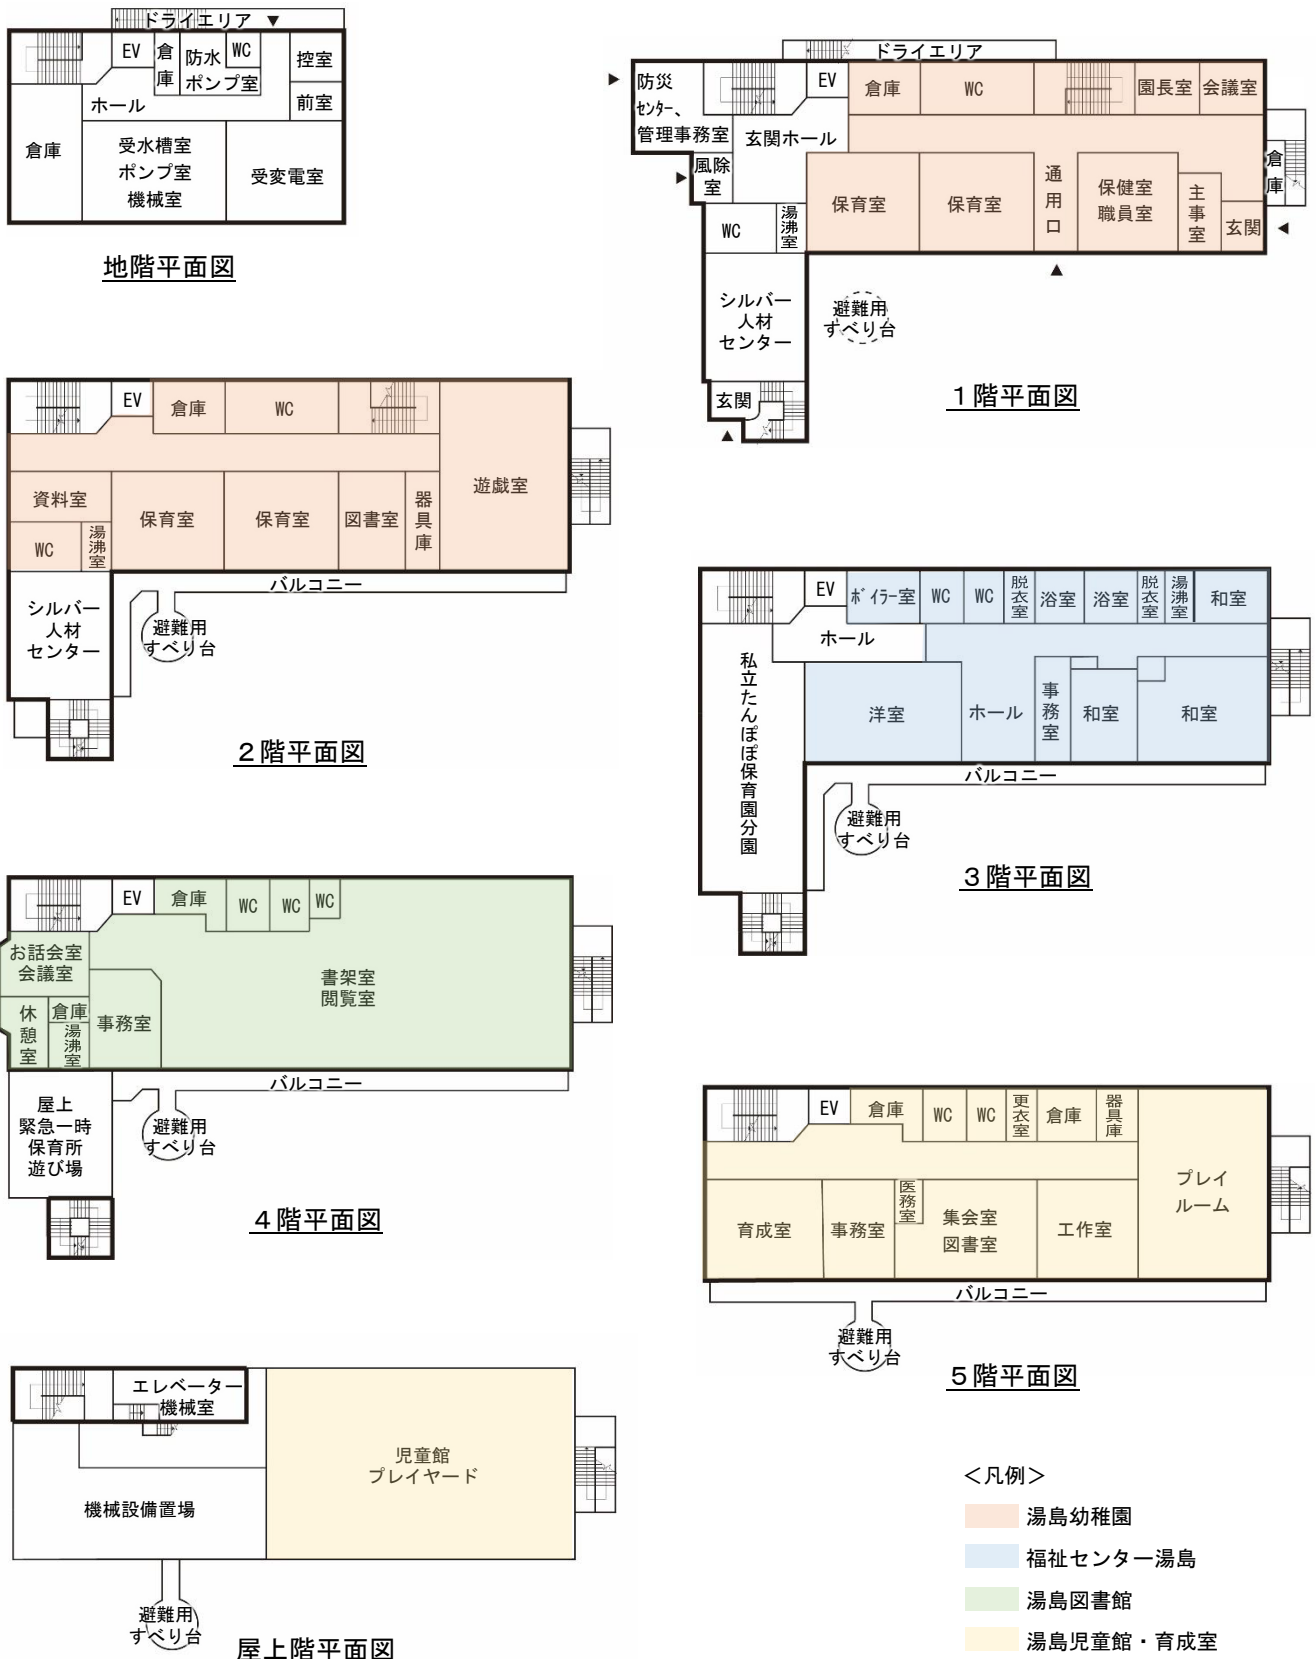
現施設の平面図 (文京区湯島総合センター案内図を参考に作成)
